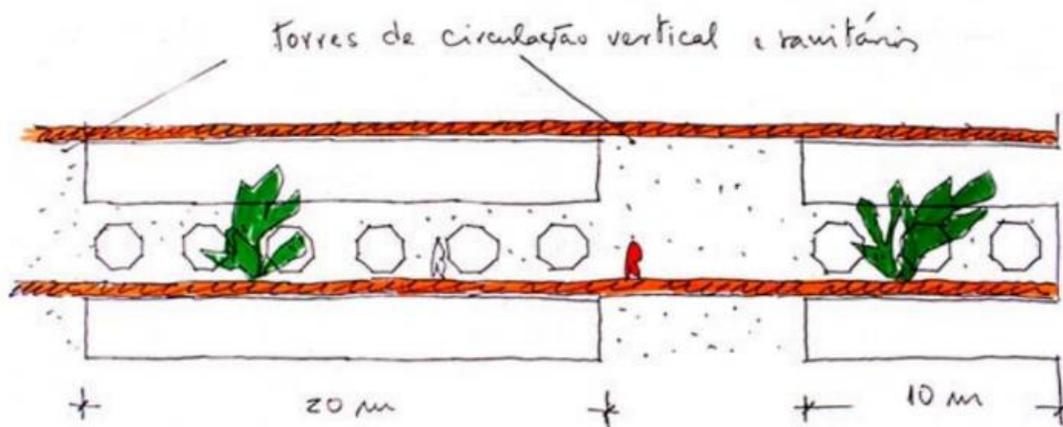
Croqui da viga tipo Vierendeel. Fonte: Arquivo fotográfico do CTRS.
